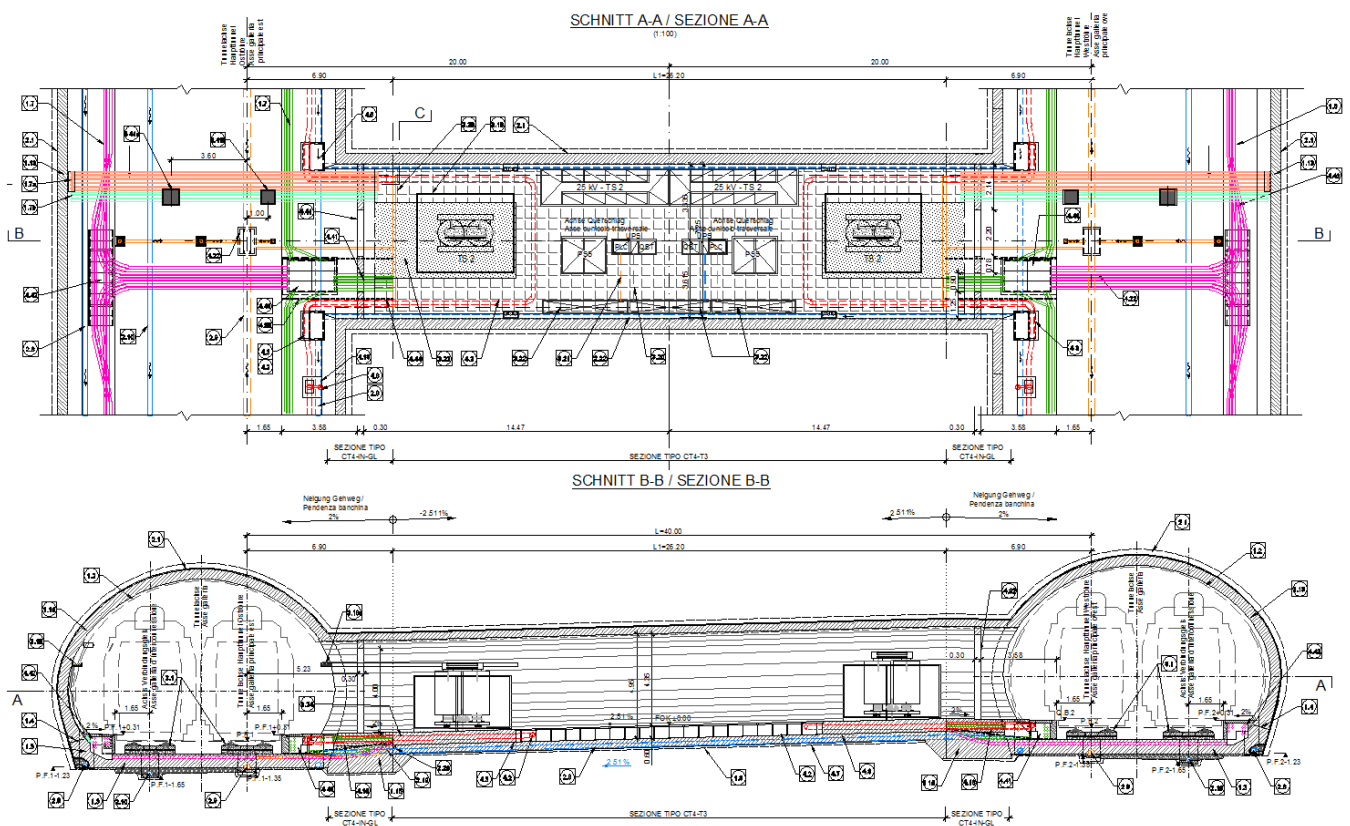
Querstollen Typ 4 - Grundriss und Längsschnitt [30].
